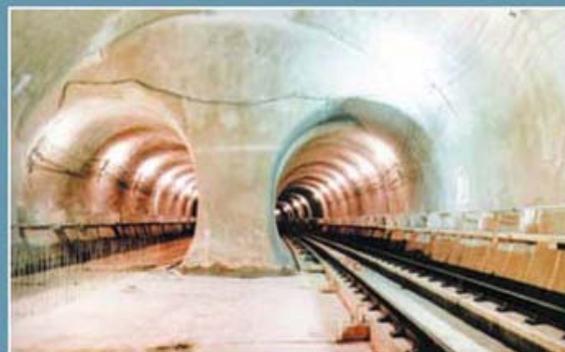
Vista do interior da estação Jardim São Paulo durante a escavação (CBT, 2006)
